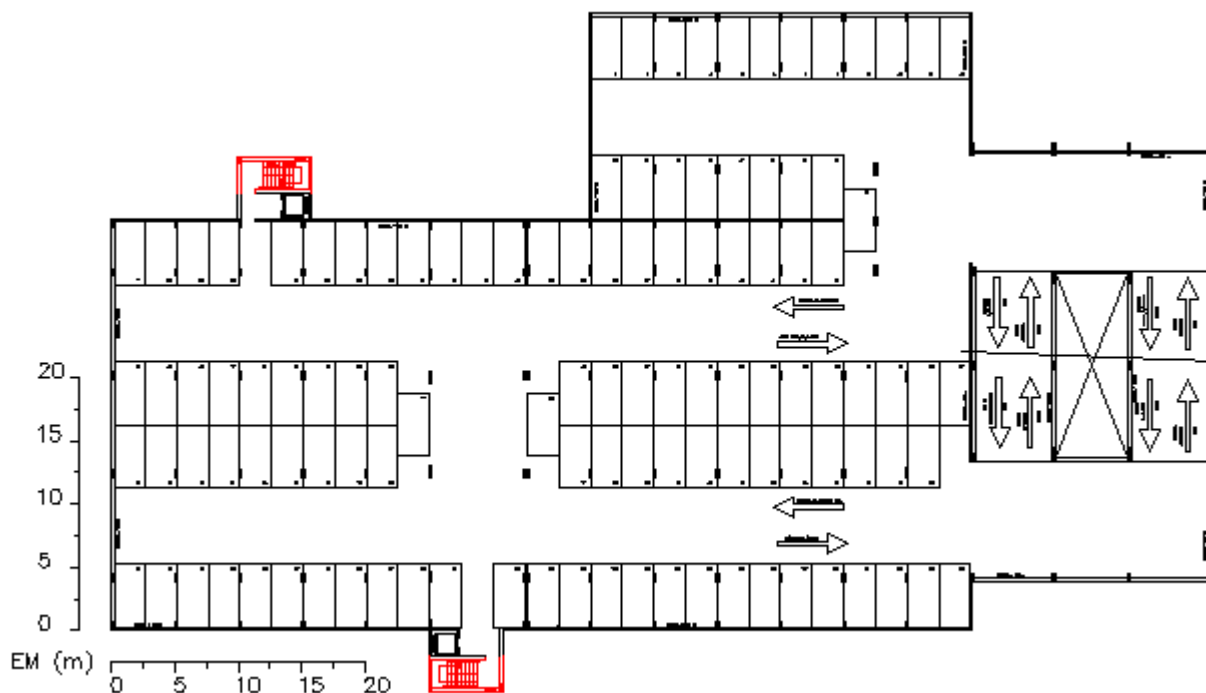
Localização das Escadas Não Enclausuradas (NE) no Pavimento Tipo (2° ao 6°)
